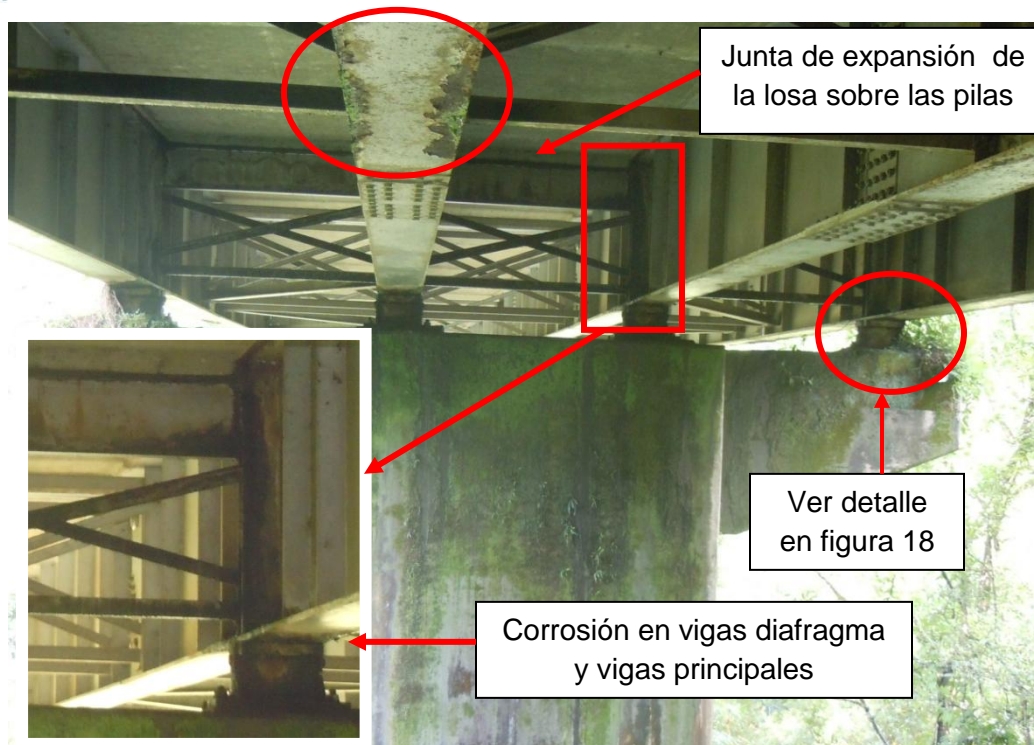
Corrosión en viga principal, vigas diafragma, arriostres y apoyos sobre la pila 1 producto del agua que ingresa por la junta de expansión de la losa ubicada sobre la pila.
